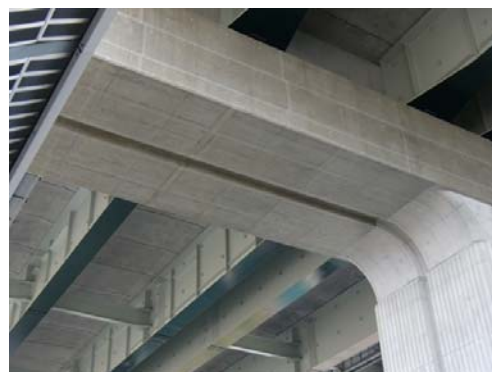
予防保全としての施工事例 (ラーメン橋脚横梁部, 施工2年後)
